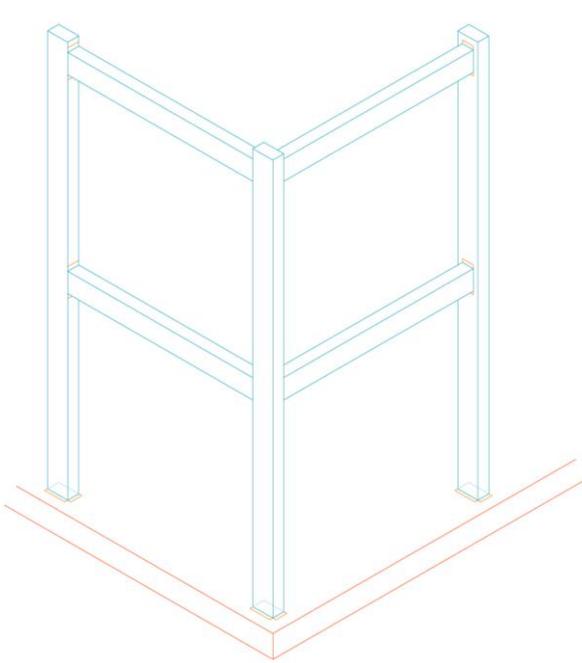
Axonometría constructiva sistema viga-pilar de madera (Dibujo original)
